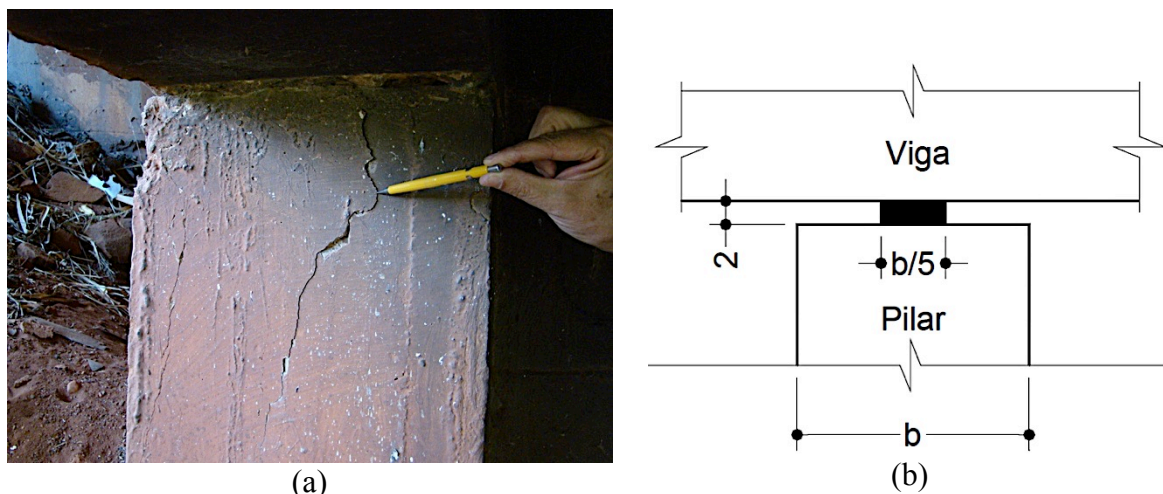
Fissura causada por concentração de tensões no topo do pilar: (a) fissura no topo do pilar; (b) esquema longitudinal de uma articulação Freyssinet (DNIT, 2004b).
